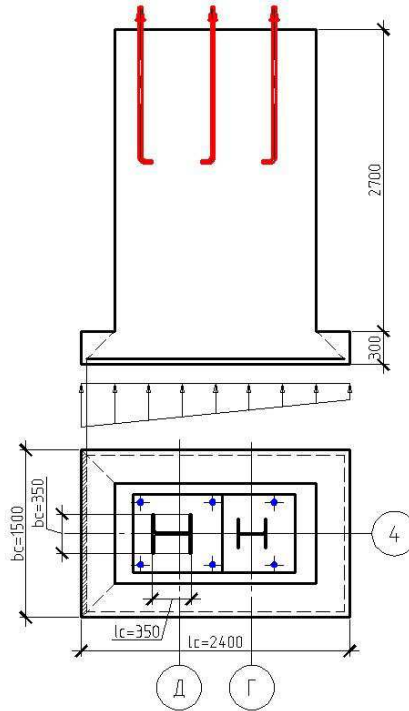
Схема к расчету низкого фундамента на продавливание подколонником
